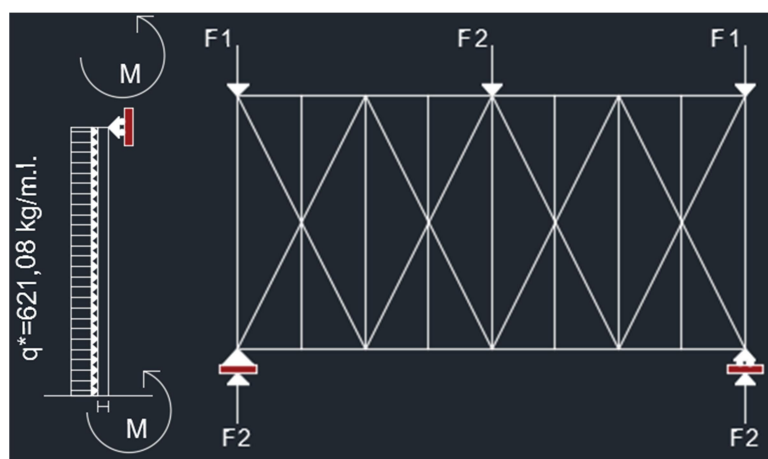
Esquemática de las cargas en los arriostramientos de cubierta
